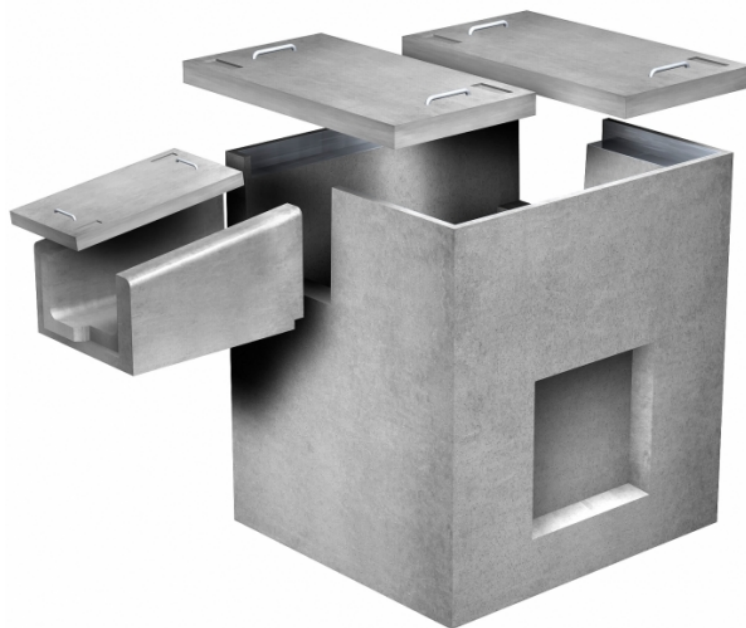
arqueta prefabricada hormigón. ADIF
